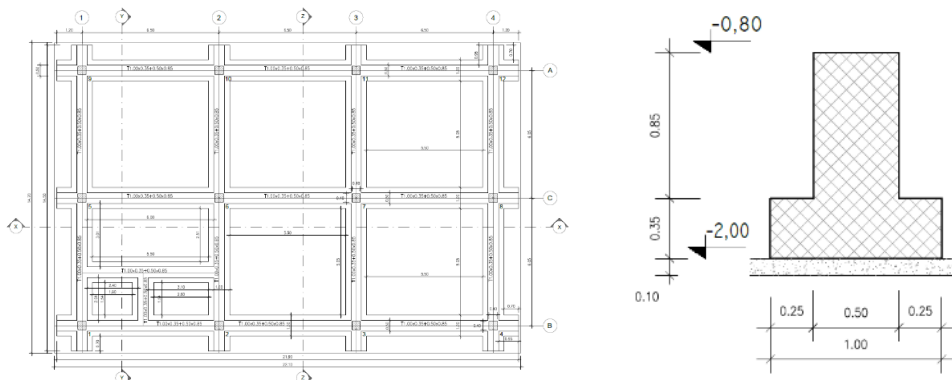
Sezione tipologica trave rovescia di fondazione e planimetria fondazione
